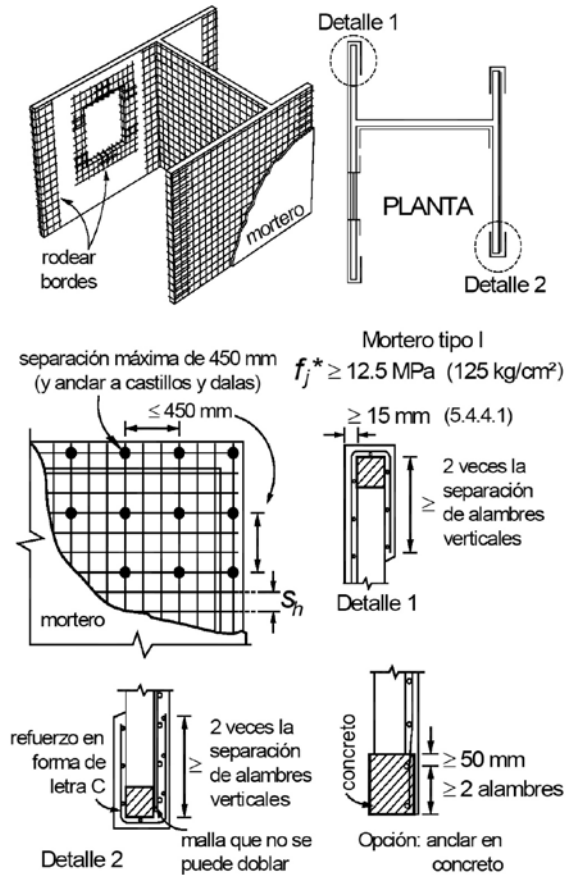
Refuerzo con malla de alambre soldado y recubrimiento de mortero.
